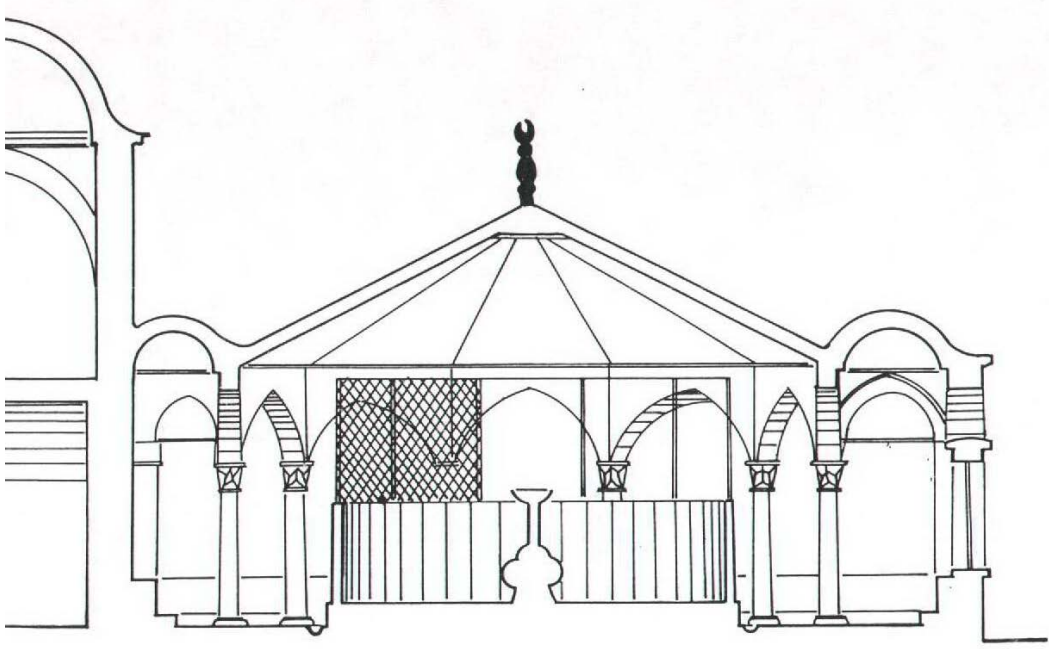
Rüstem Paşa Camii Şadırvan Planı ³¹⁸
